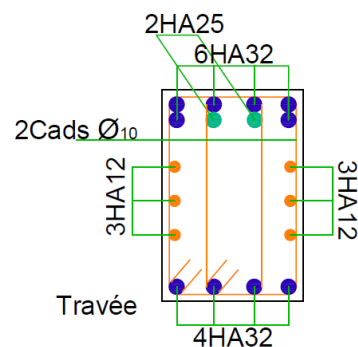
Schéma de ferrailage (section transversale) en travée
